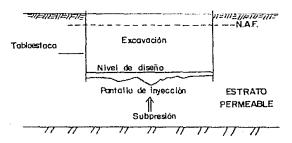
PANTALLA DE INYECCION HORIZONTAL.
